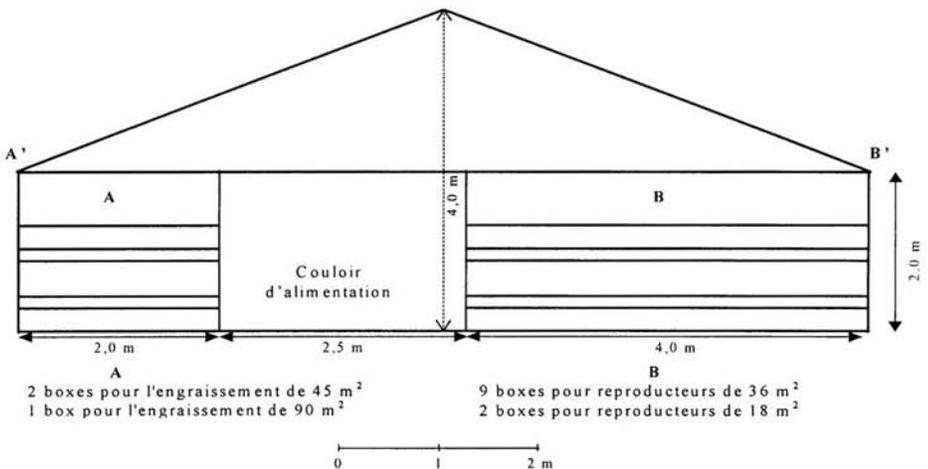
Coupe transversale de la serre principale de l’exploitation d’élevage-engraissement.
